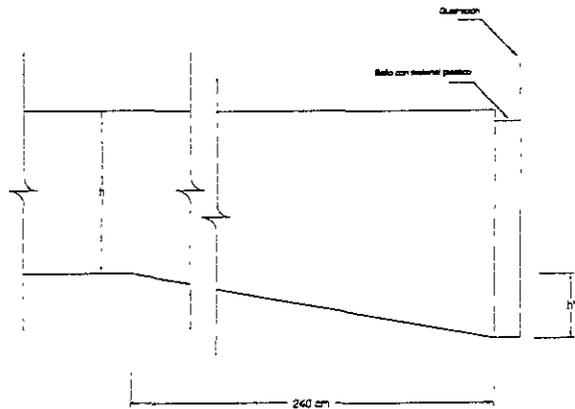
Juntas de expansión aperaltadas, sin refuerzo de acero. Planta de Producción de Sílica, Altamira, Tamps.
